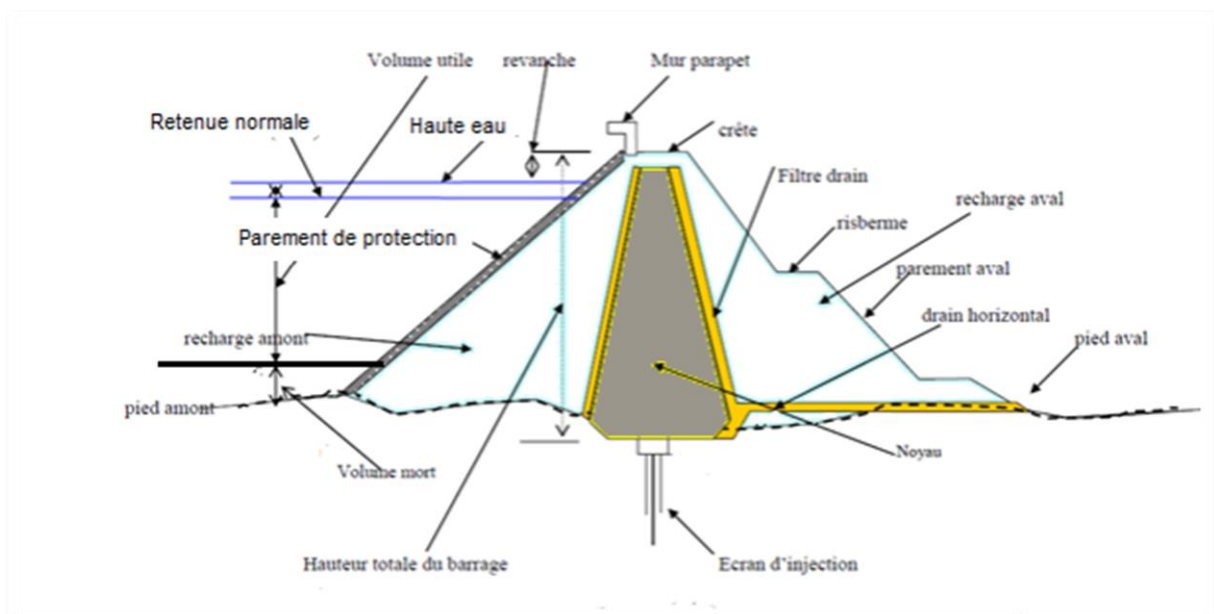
Coupe schématique d'un barrage en remblai (Millogo Founémé, 2009).
